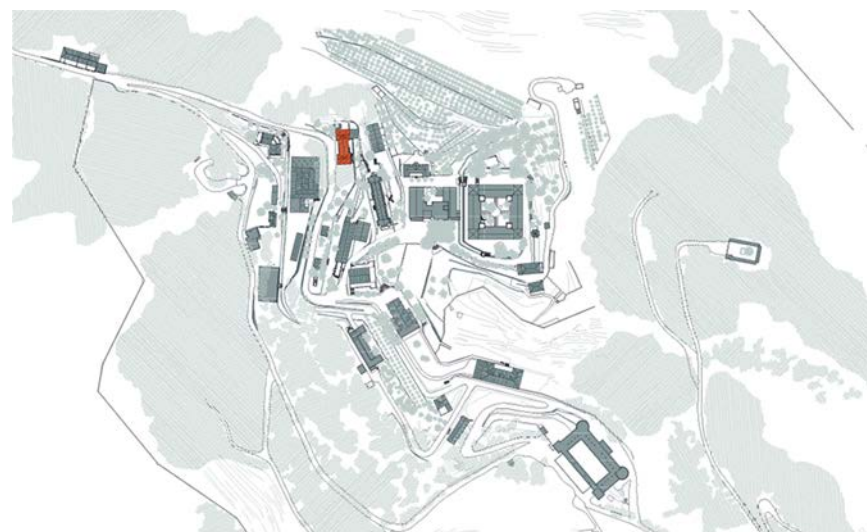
Plano de emplazamiento. Pabellón de Administración, actual Hospedería.
